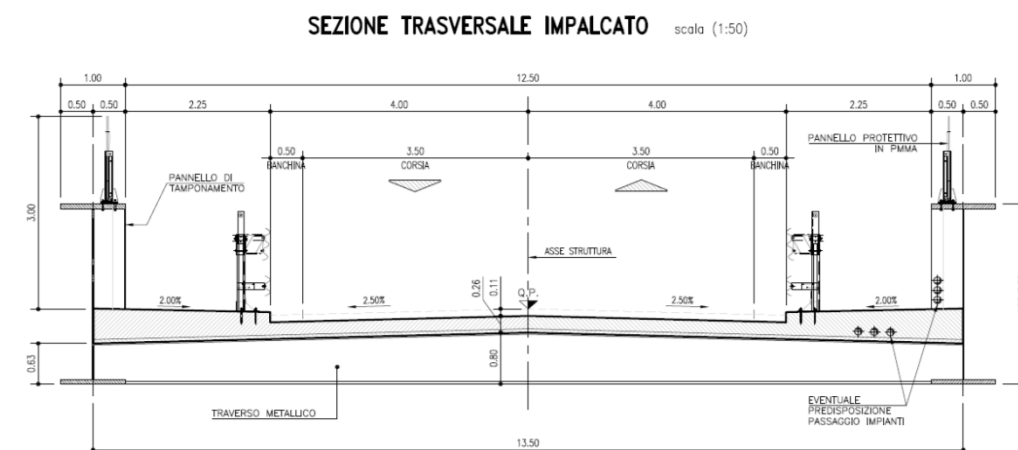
Sezione trasversale cavalcavia a via inferiore
